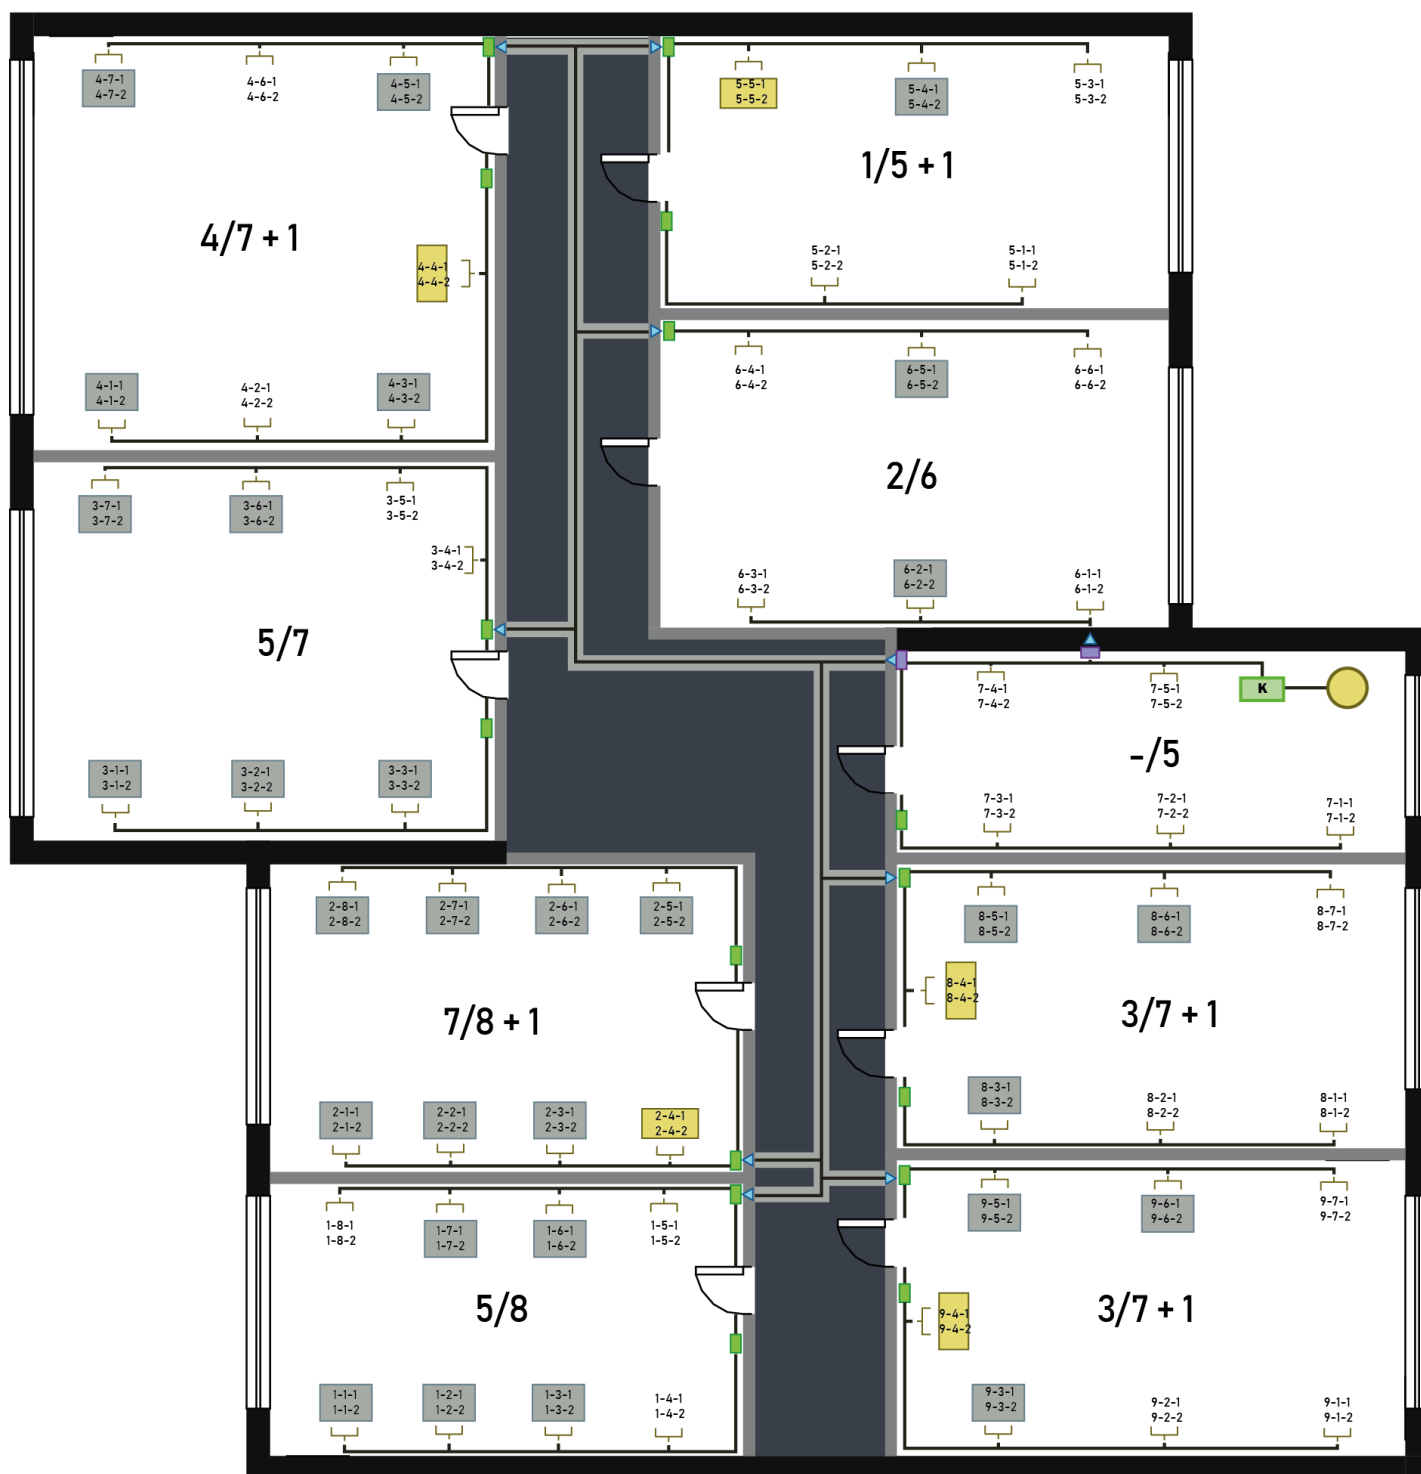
Детальный план здания №3, этаж – 2 (высота – 3600 мм)
